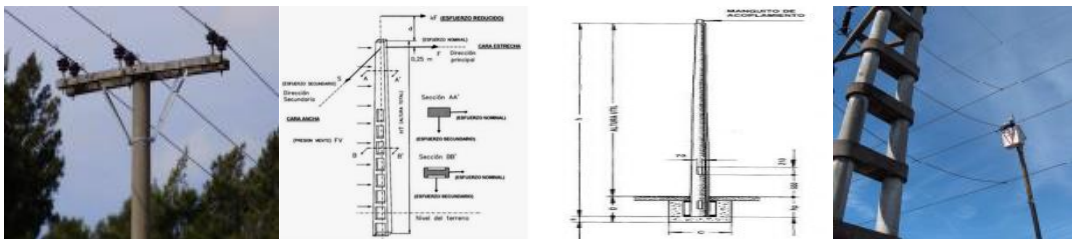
Postes de hormigón: armado, vibrado, centrifugado y pretensado [2].
